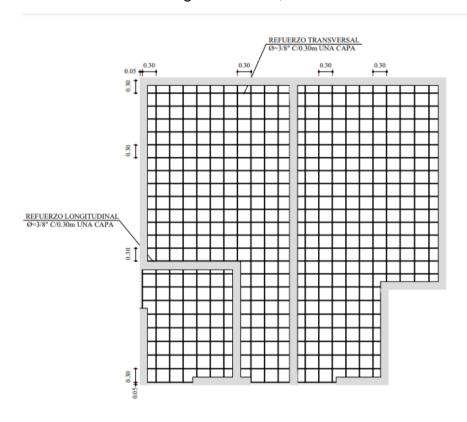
Plano estructural de losa de contrapiso, acero de refuerzo. Fuente: COASCON S.A.S
